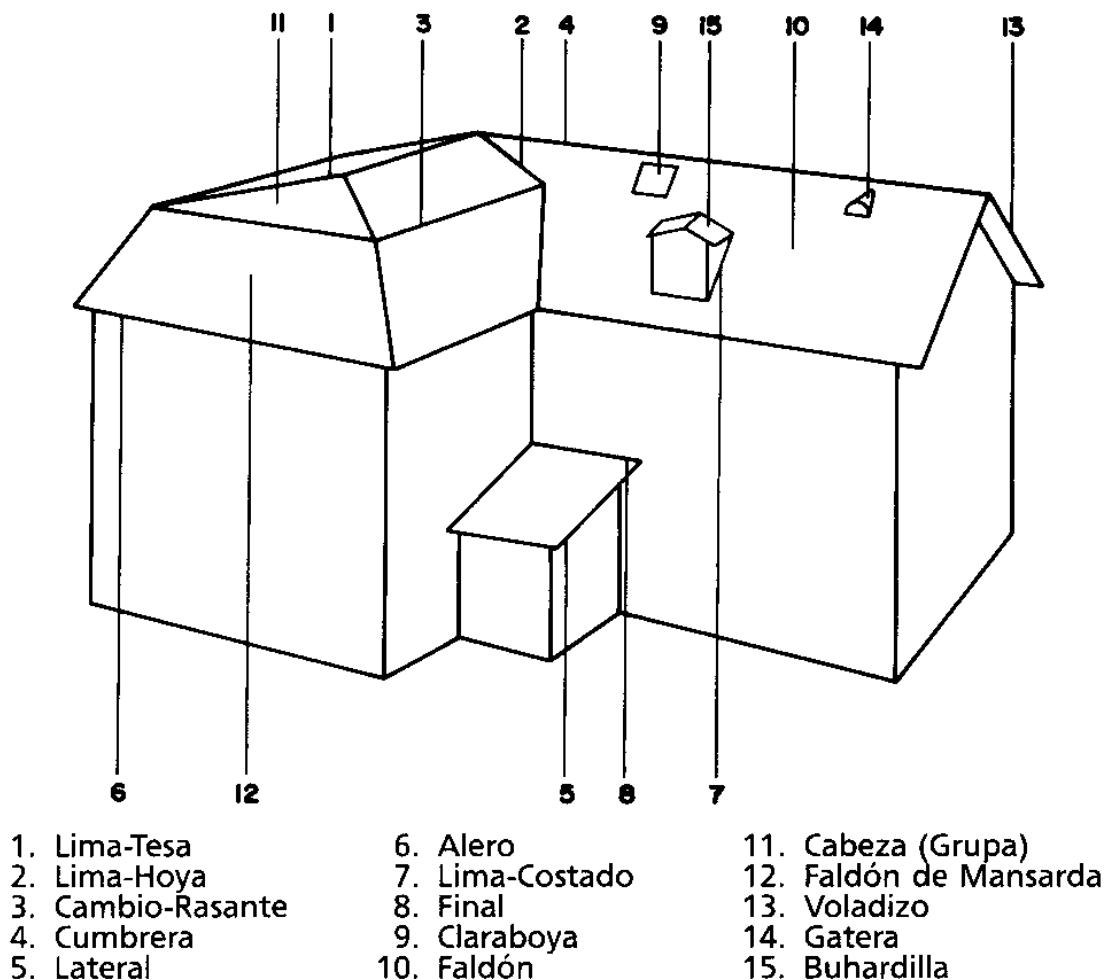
Esquema de los elementos constitutivos de una cubierta.
